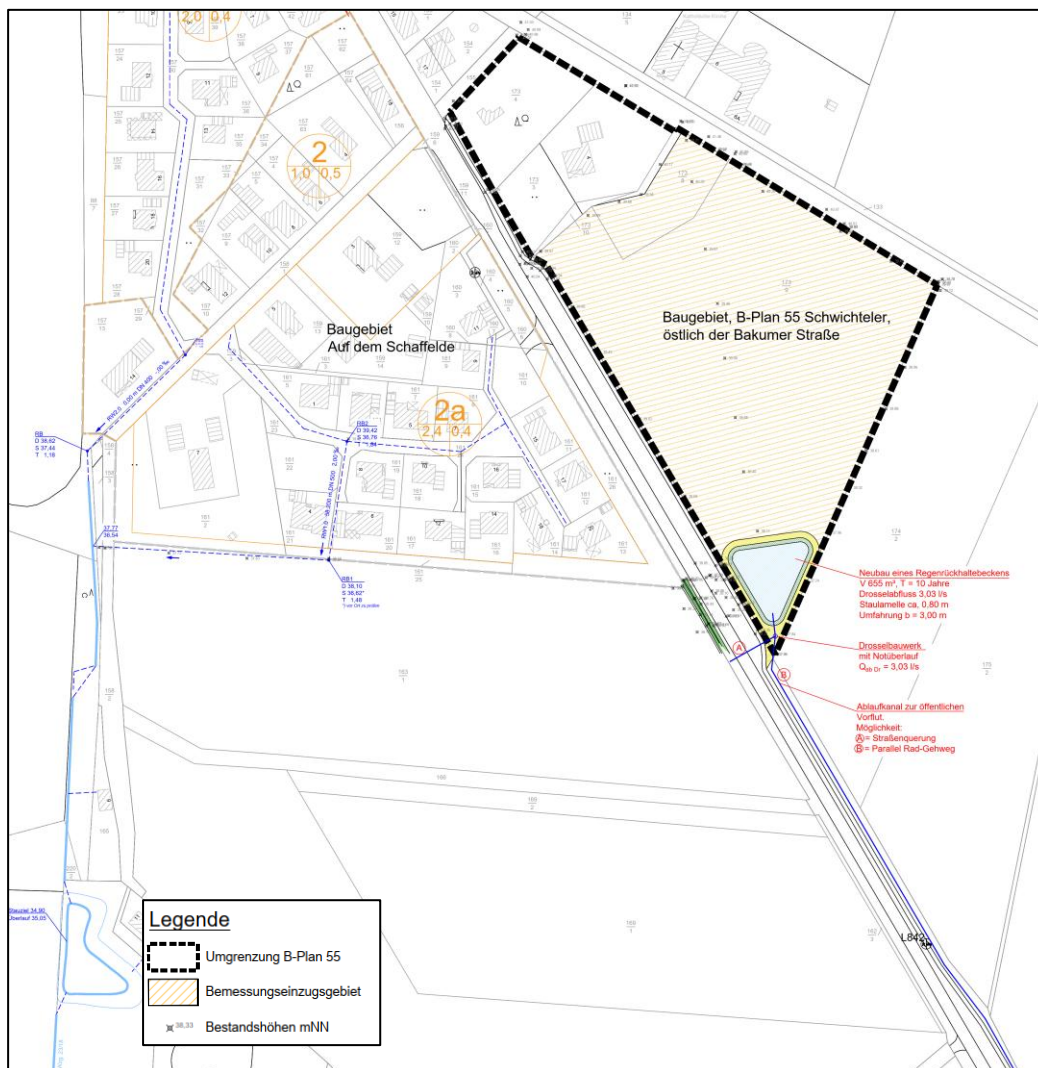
Lageplan des Oberflächenentwässerungskonzeptes (Vorabzug)
